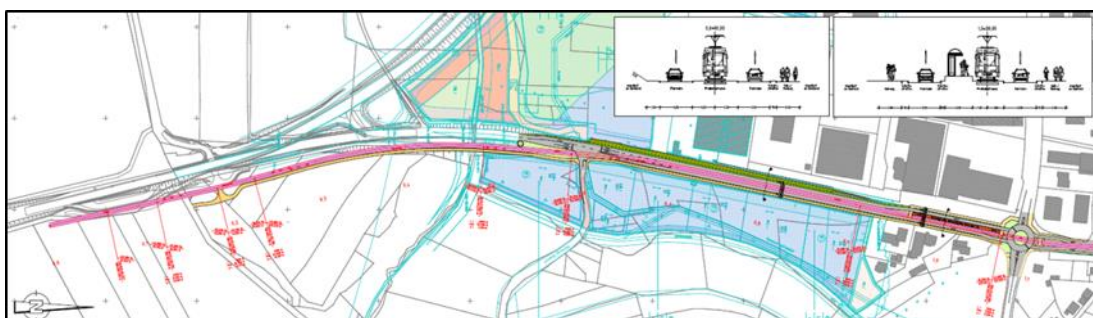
TTK-Studie – Gesamtlageplan Variante Mittellage im Bereich Gaisbach Süd
